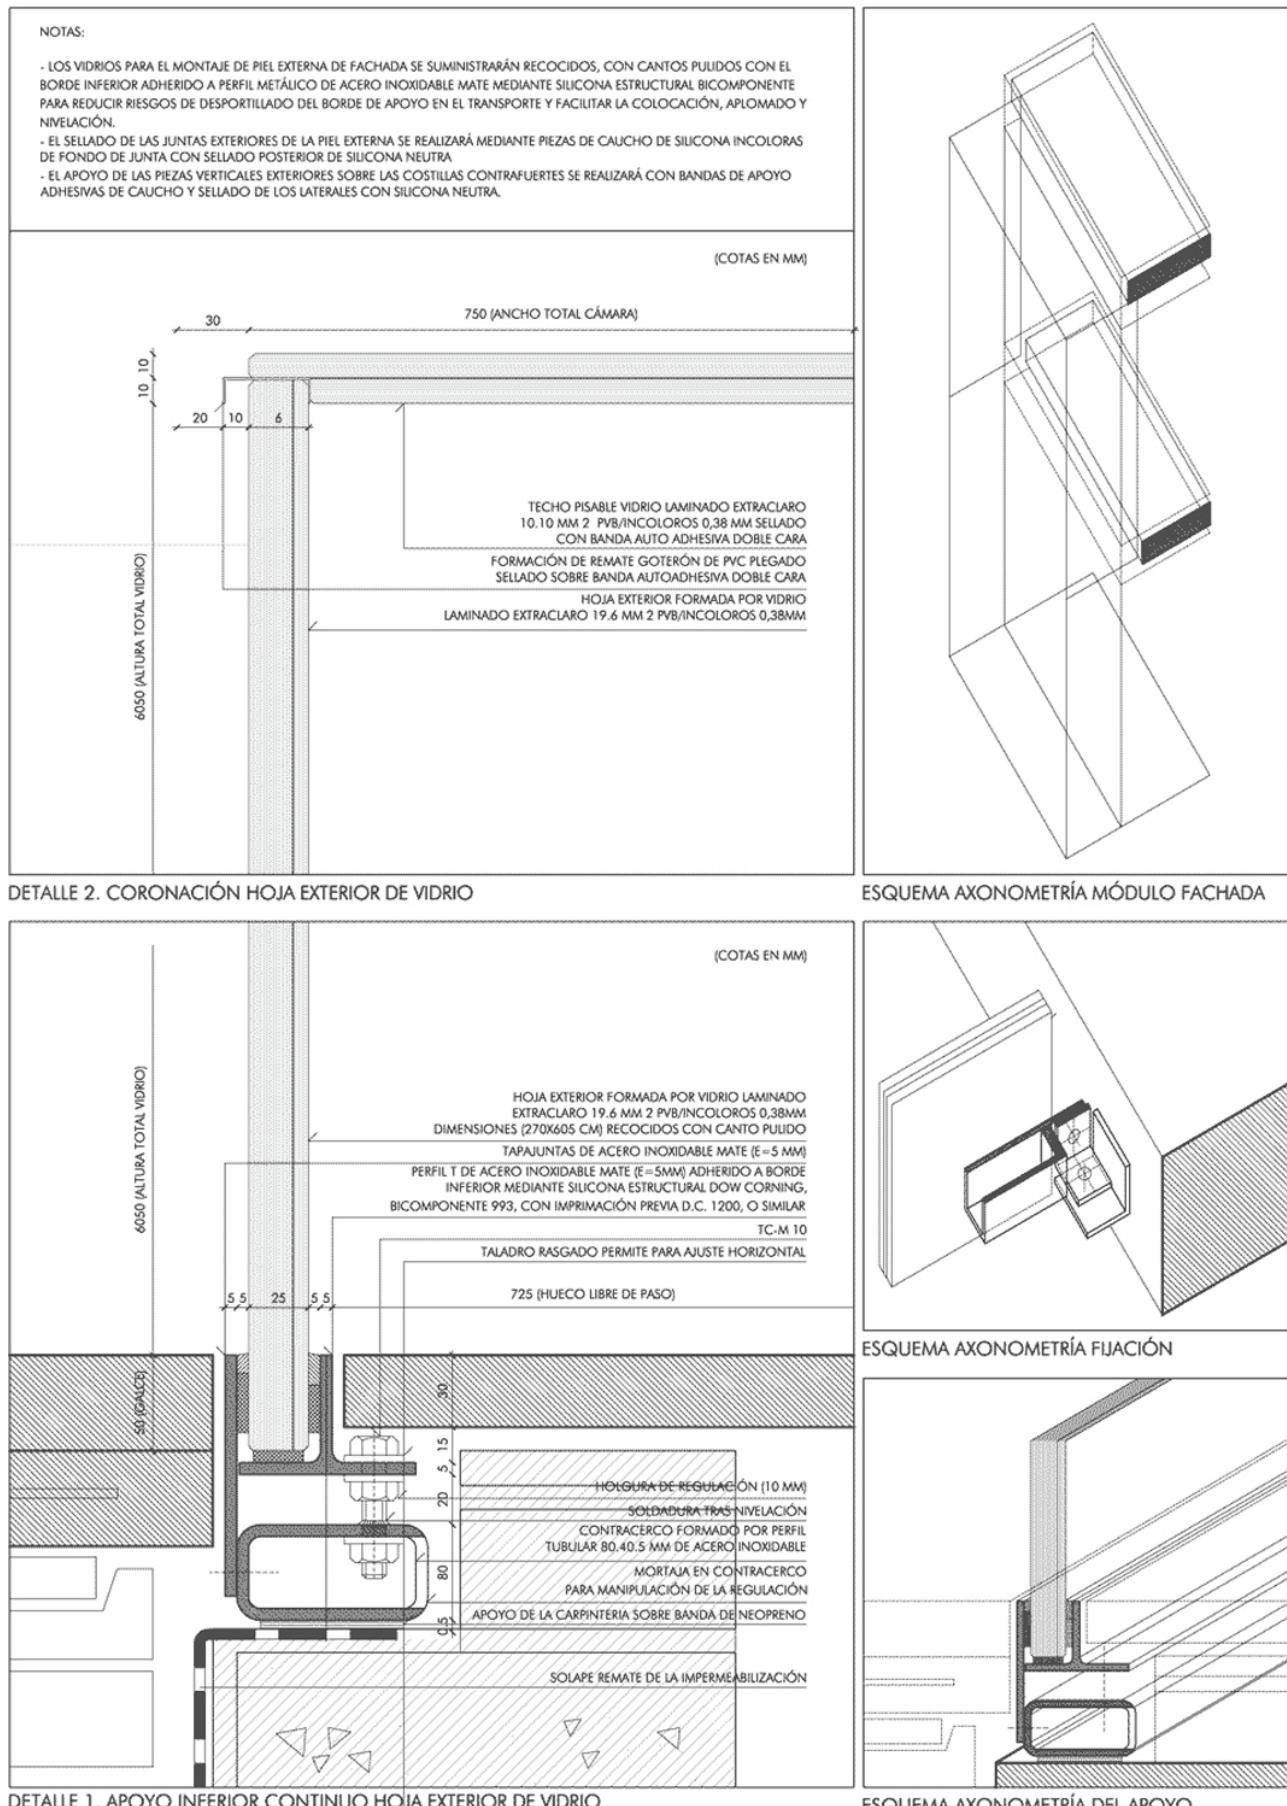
Detalles constructivos de fachada del edificio de oficinas en Zamora de Alberto Campo Baeza (2).
